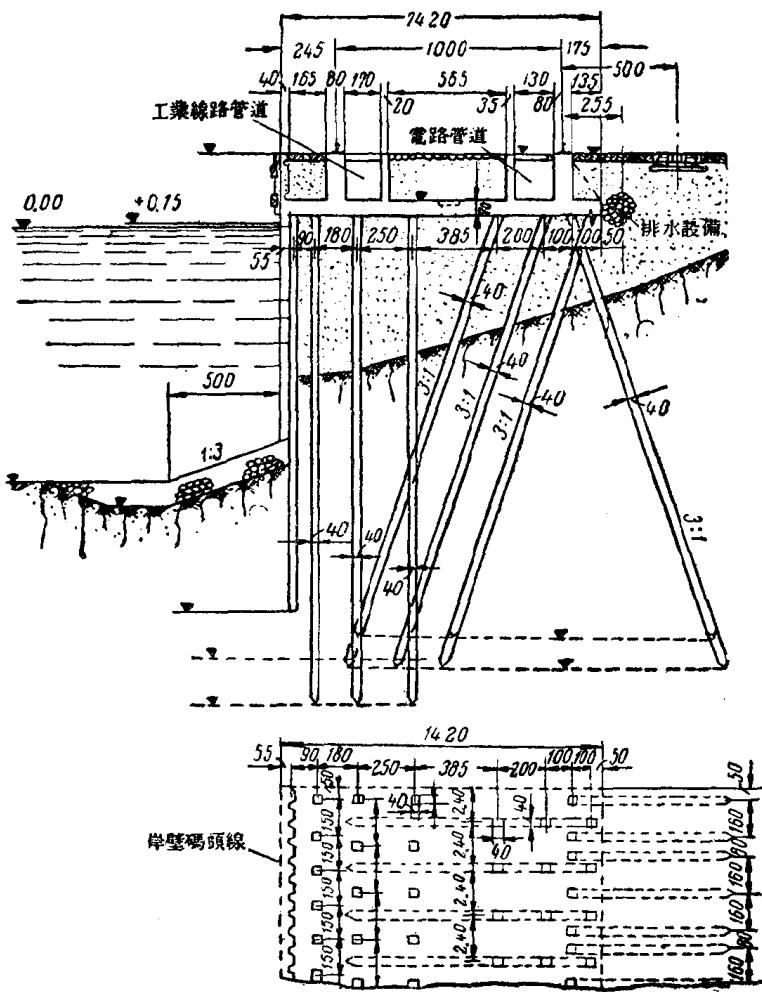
支持在鋼筋混凝土樁基上的鋼筋混凝土半剛性樁台岸壁(前面的
